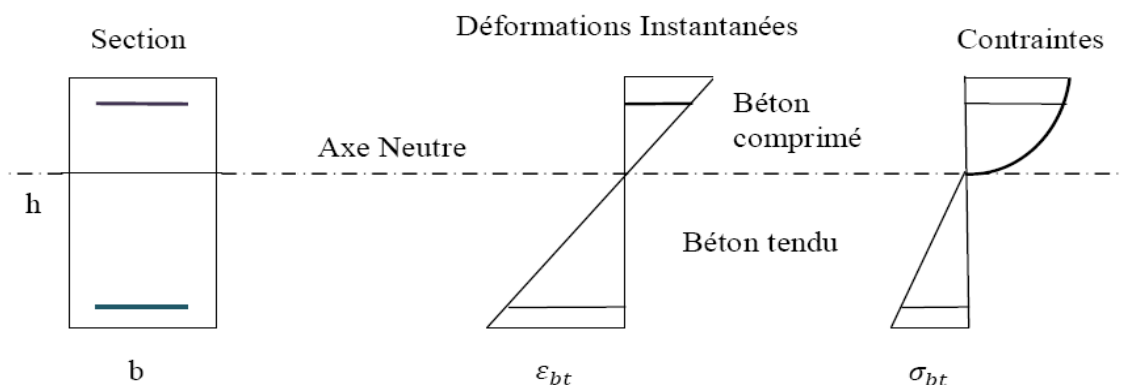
Comportement de béton ordinaire avant fissuration
